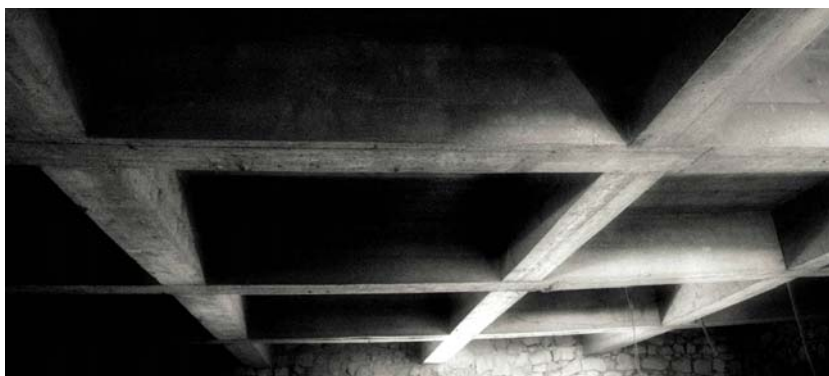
Zastosowanie betonu monolitycznego do rozwiązań konstrukcyjnych w zabytkowym budynku murowanym, w którym występuje również szkło oraz stal
